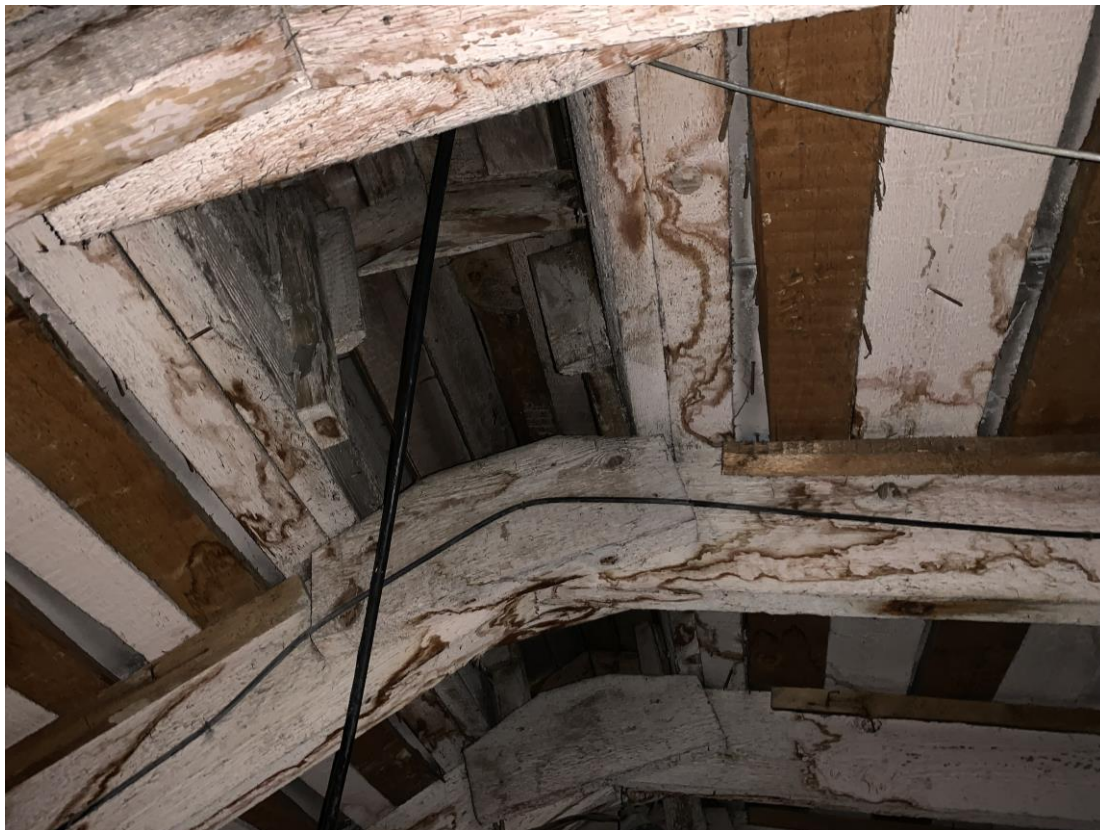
Вентиляционные выпуски канализационных стояков: не выведены за уровень кровли.
